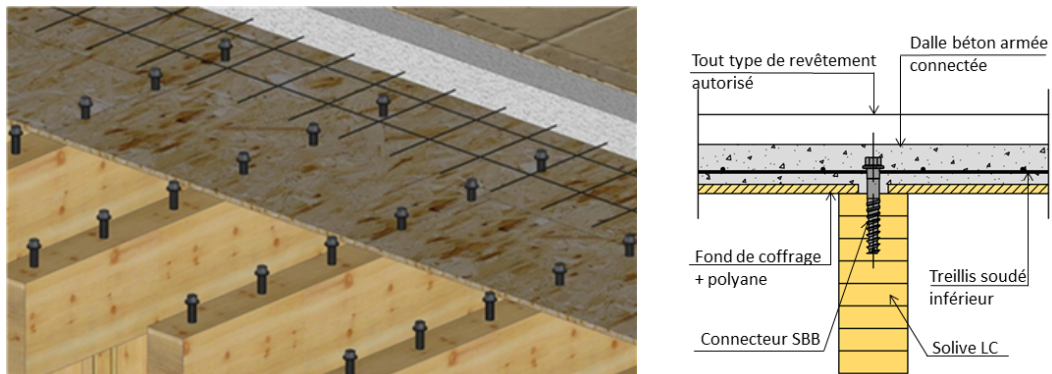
Schéma de principes de plancher mixte SBB®
